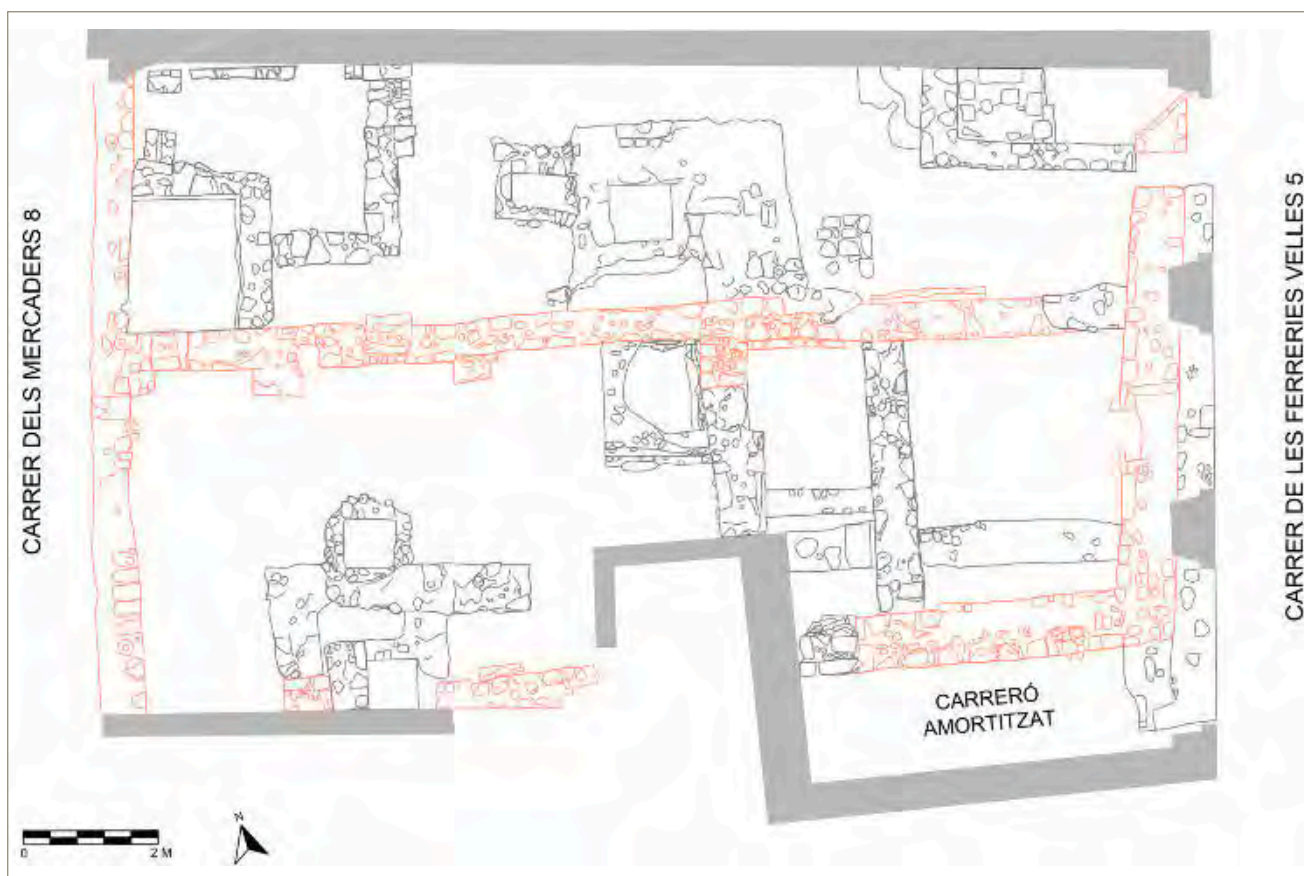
Planta general de la intervenció un cop retirades les fases contemporànies i actuals. Ressaltem en color la planta corresponent a la primera construcció documentada al solar.
